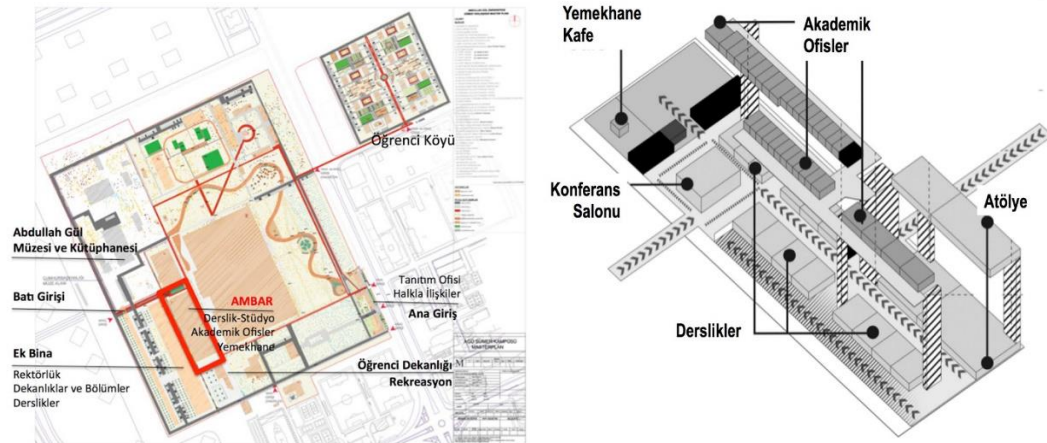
Agü Sümerbank Ambar Binası plan şemaları
